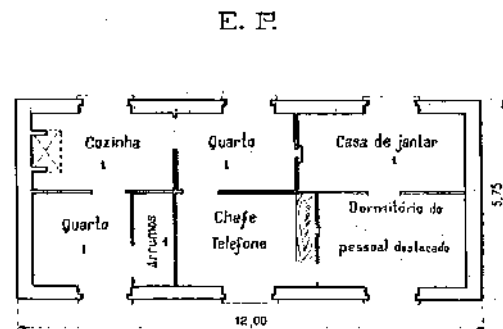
Planta do Edifício de Passageiros (E.P.)
